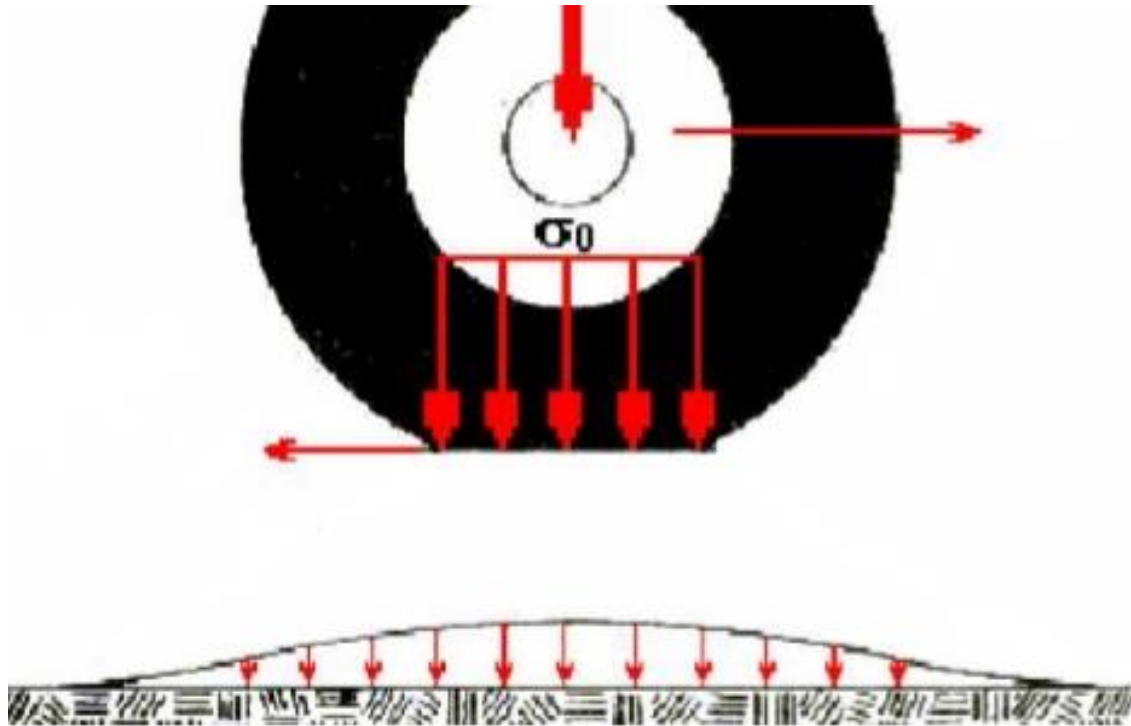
Cargas aplicadas em um pavimento (Silva, 2011).
